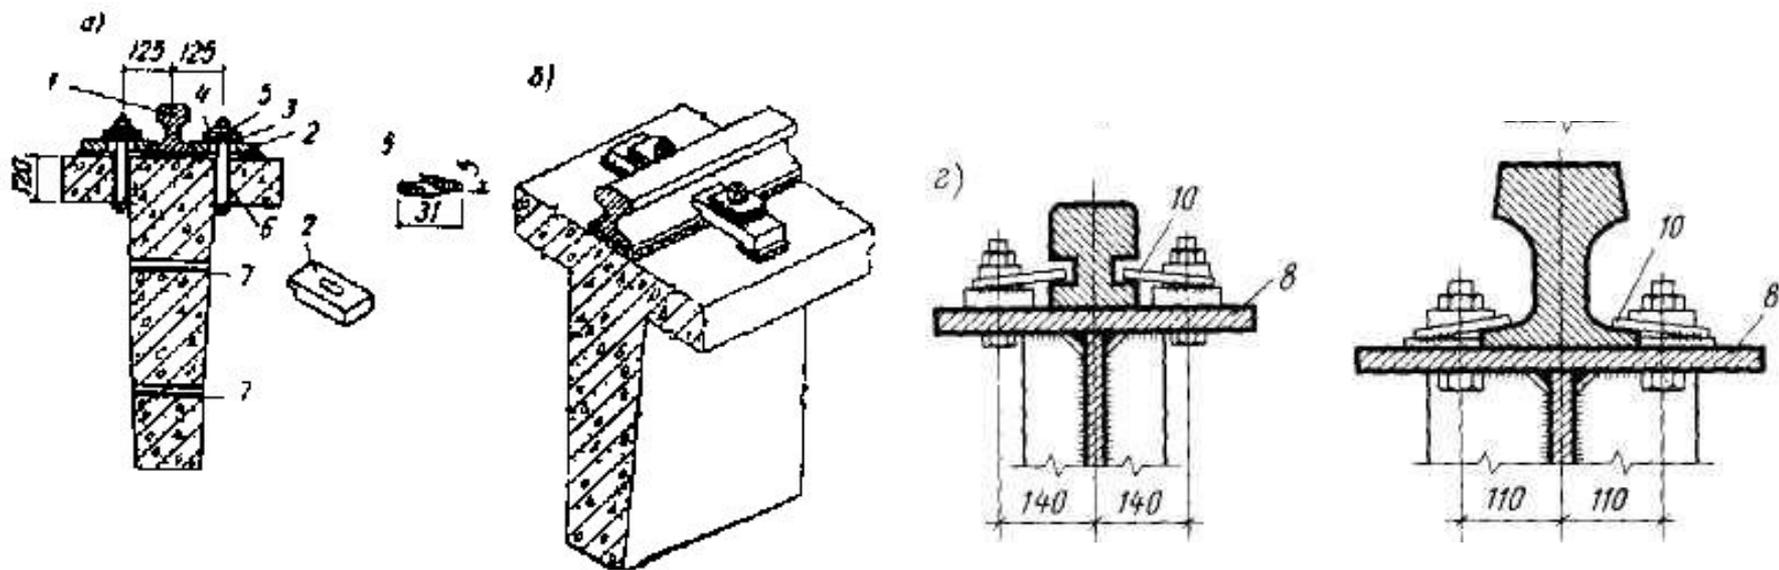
Крепление кранового рельса к железобетонной подкрановой балке
